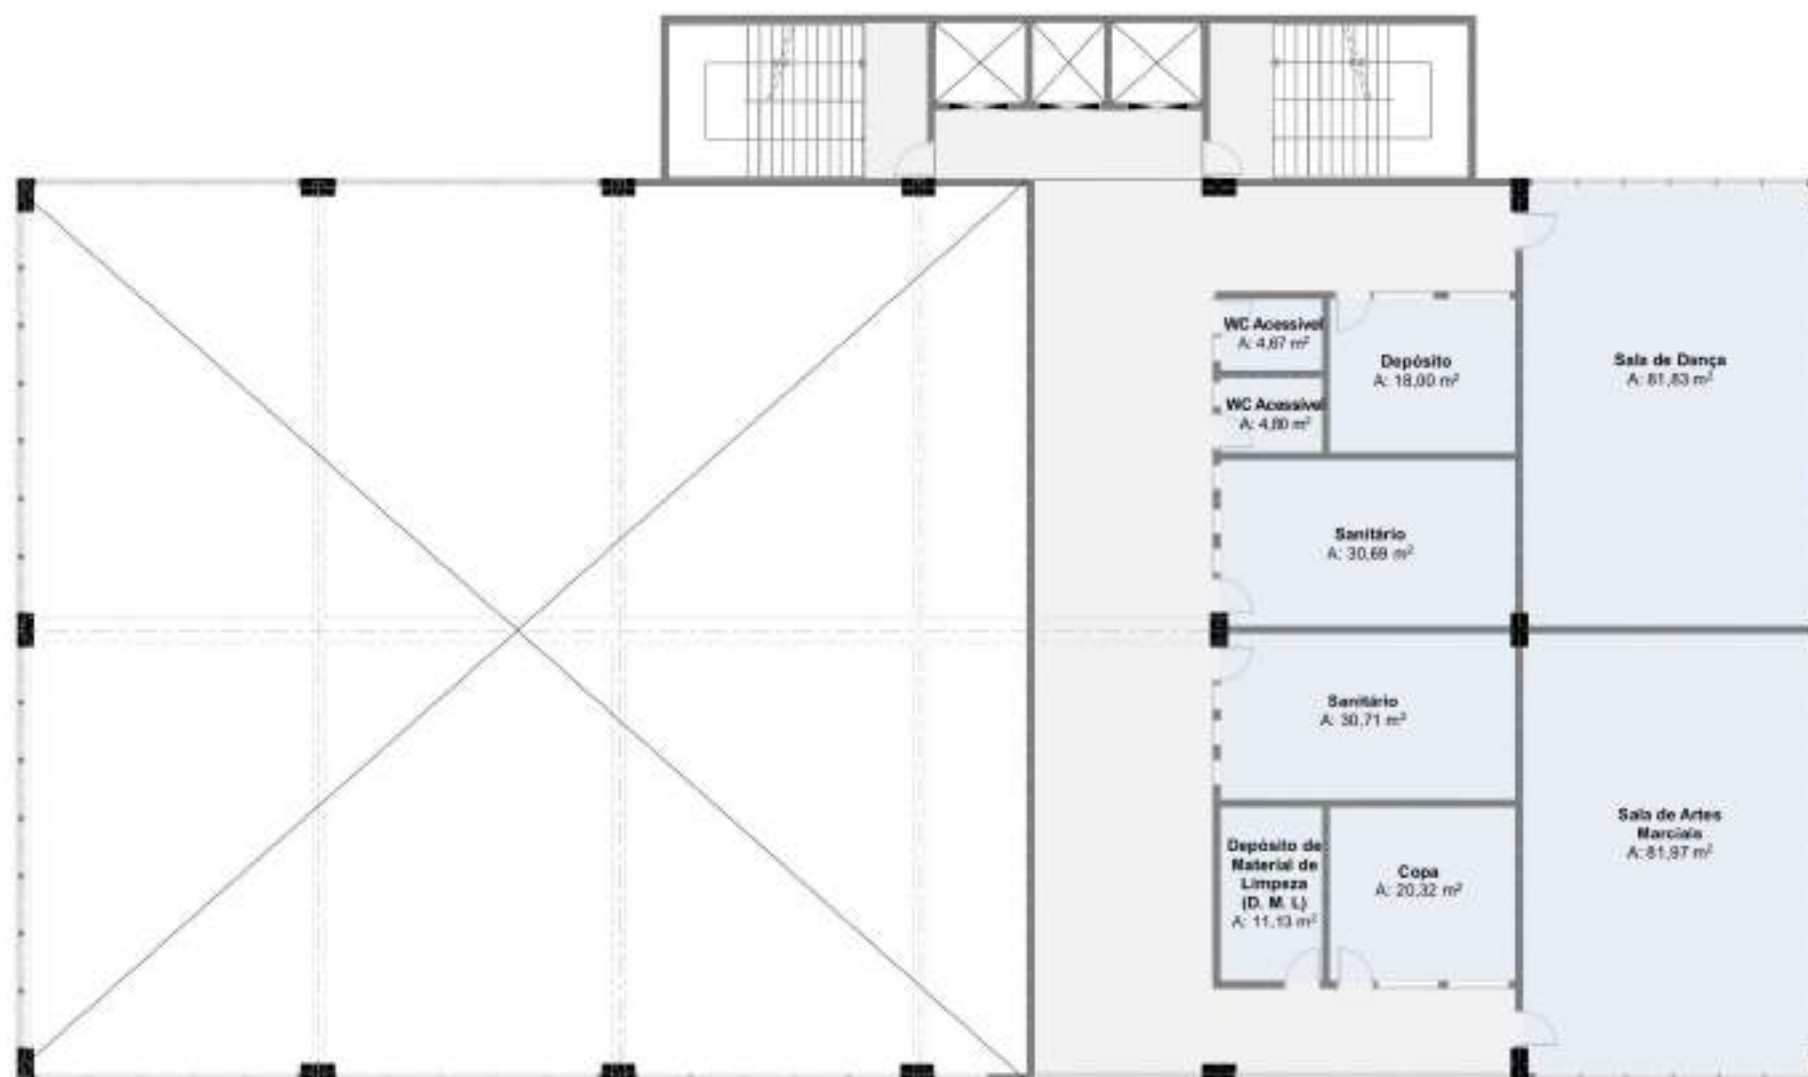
Planta Referencial Quarto Pavimento - MINICEU Tipologia 2
